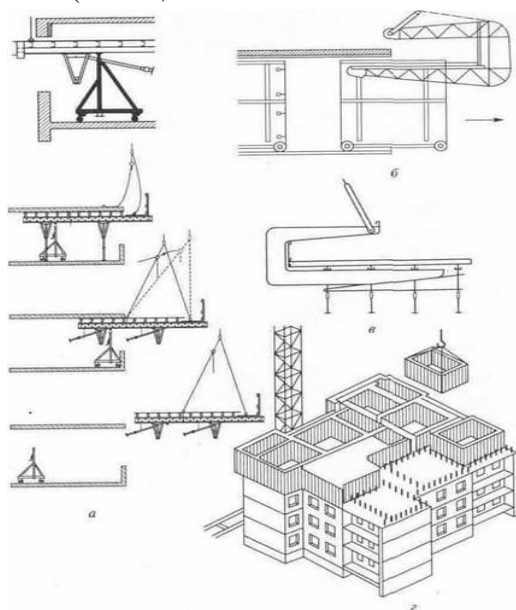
Порядок демонтажа элементов объемно-переставной опалубки.
